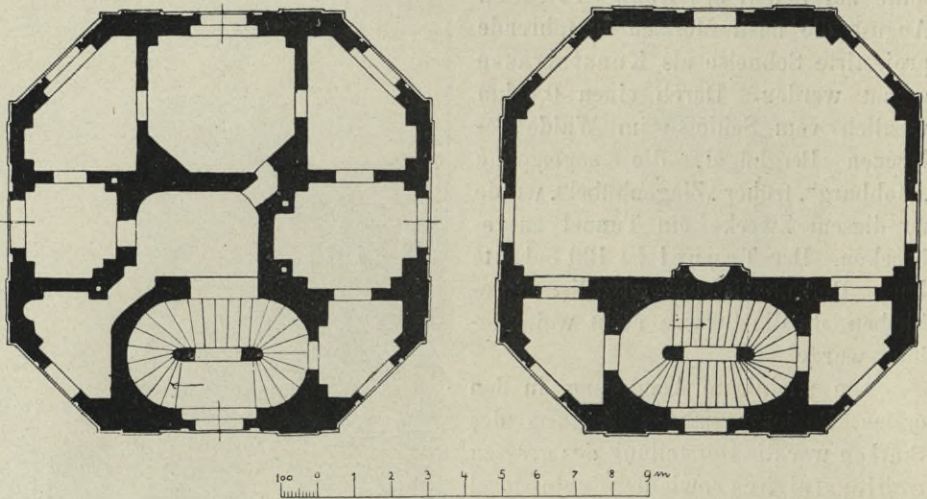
u. 124. Moritzburg, Hellhaus, Grundriss des Erd- und ersten Obergeschosses.
